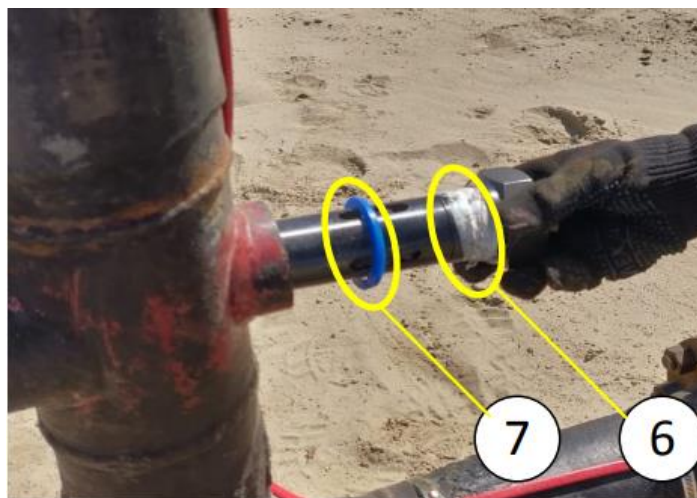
Подготовка к установке нового обратного клапана
